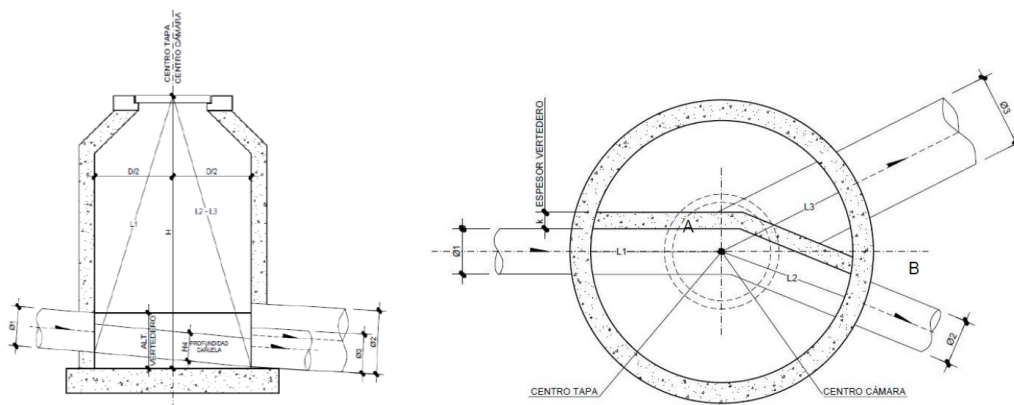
Planta de levantamiento de un aliviadero transversal con cañuela de fondo.
